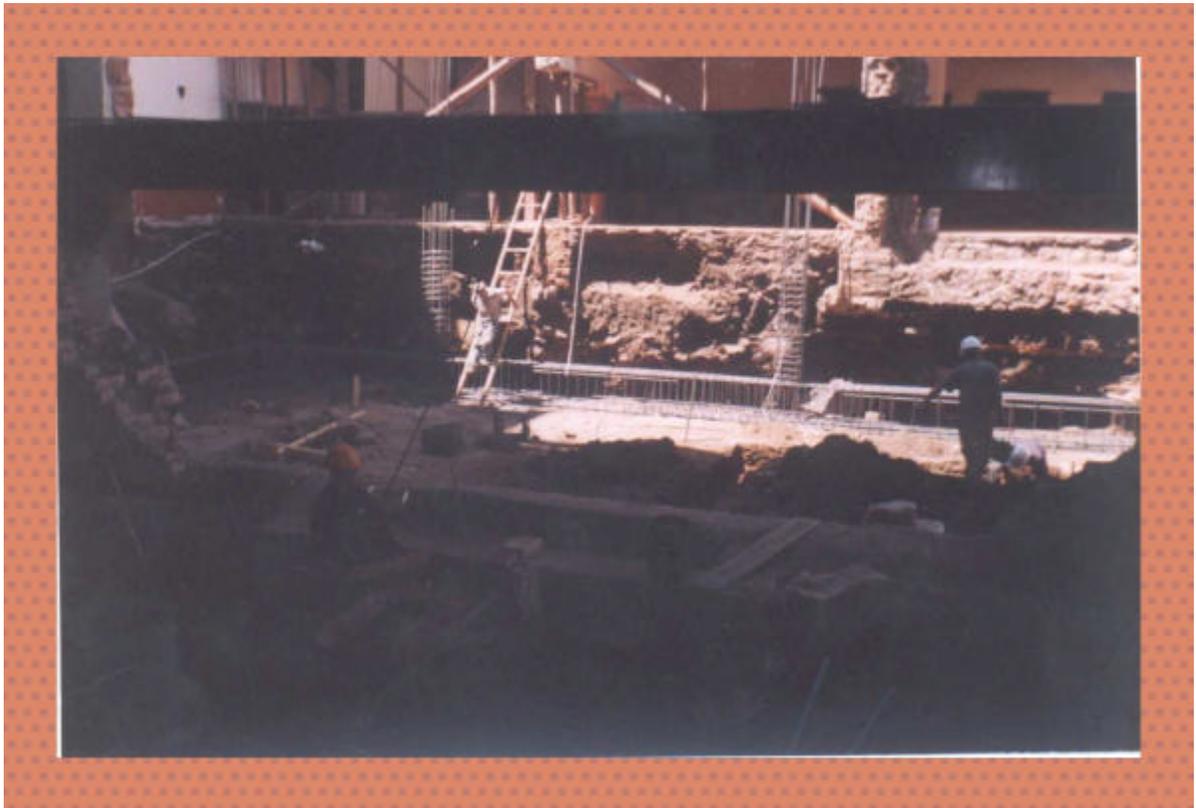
Anclajes de 30cm hechos a la zapata excéntrica para empatar la viga de cimentación
